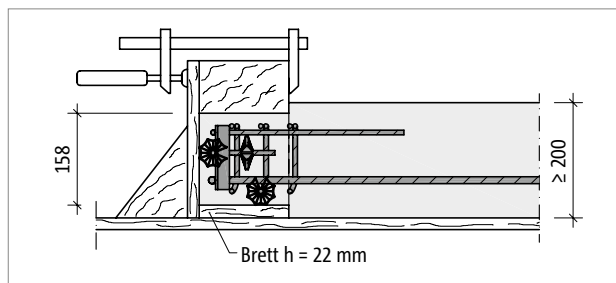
Schöck Tronsole® Typ Z: Herstellung einer Auflagerkonsole am Elementpodest; Podestplattendicke $h \geq 200$ mm
